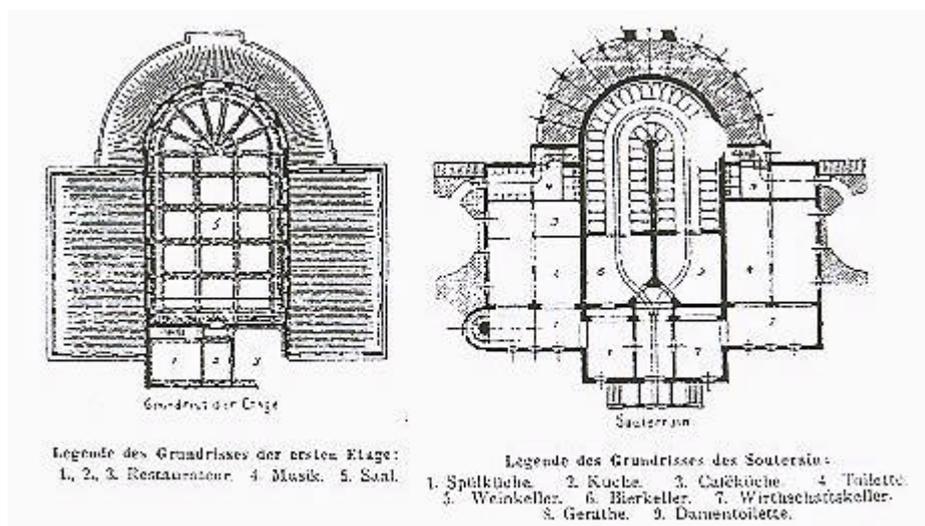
, 2 Grundrisse (Souterrain und 1. Obergeschoß) des Restaurationsgebäudes, Entwurf von Tüshaus und Abbema
